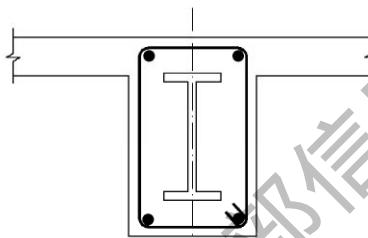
型钢混凝土梁的型钢截面配筋形式
